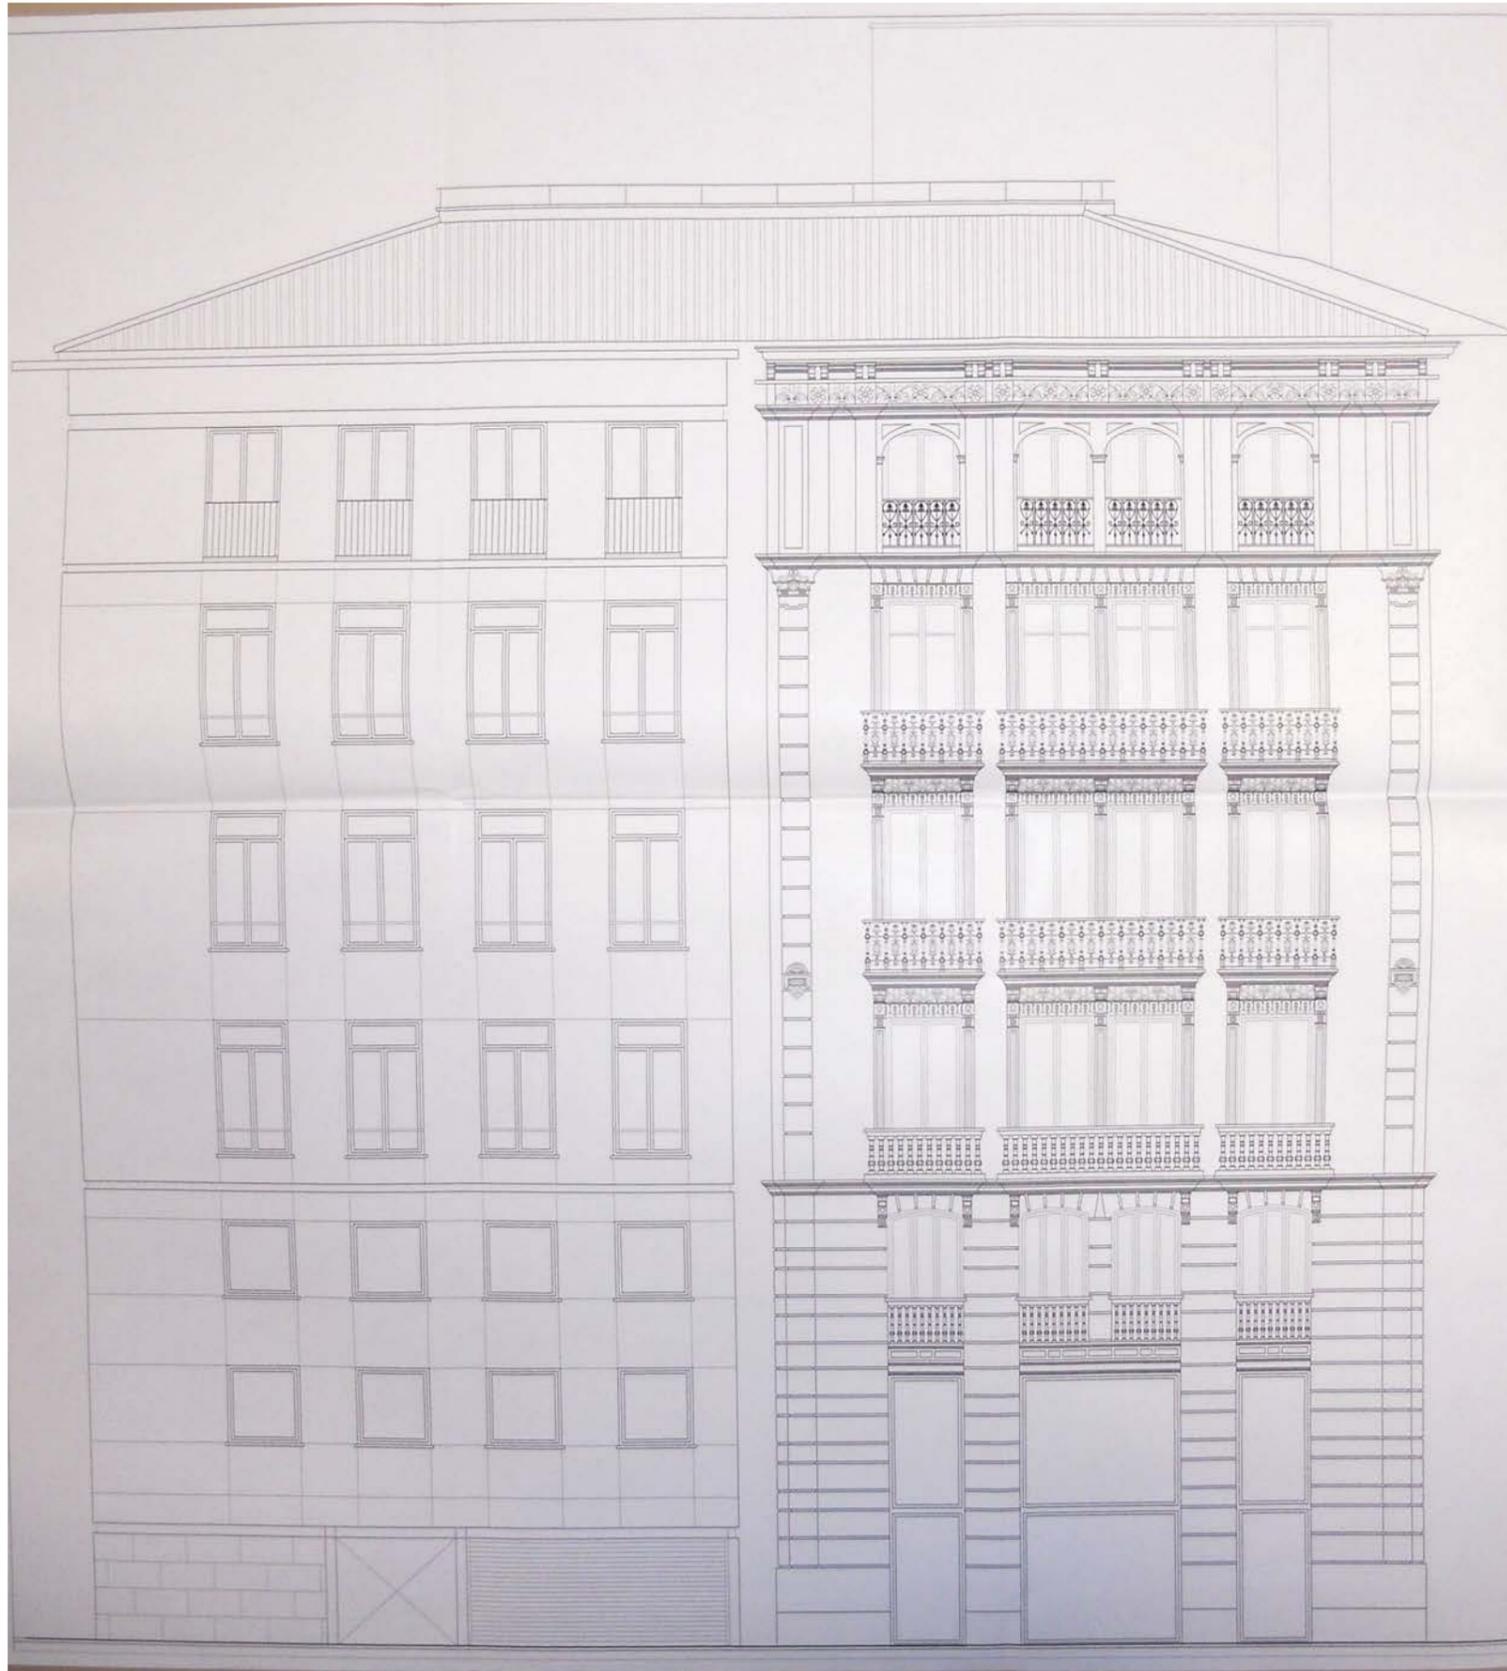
Plano Alzado Calle San Juan de Ribera.
